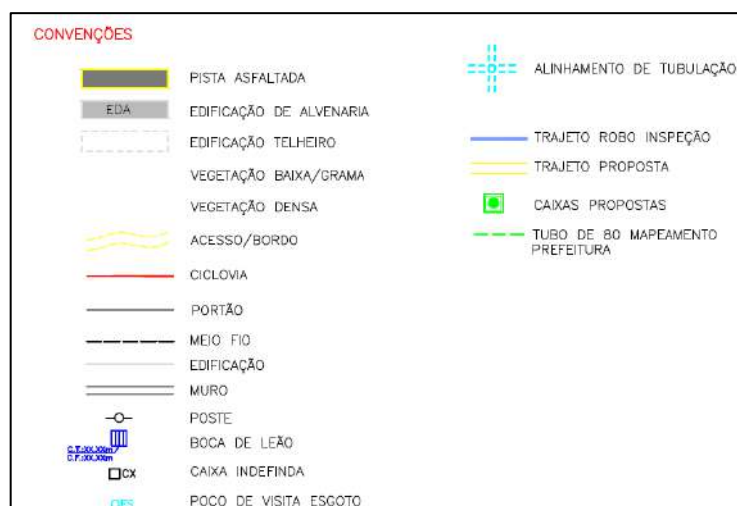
Legenda da planta de situação apresentada acima. Fonte: Progeo, 2026.
